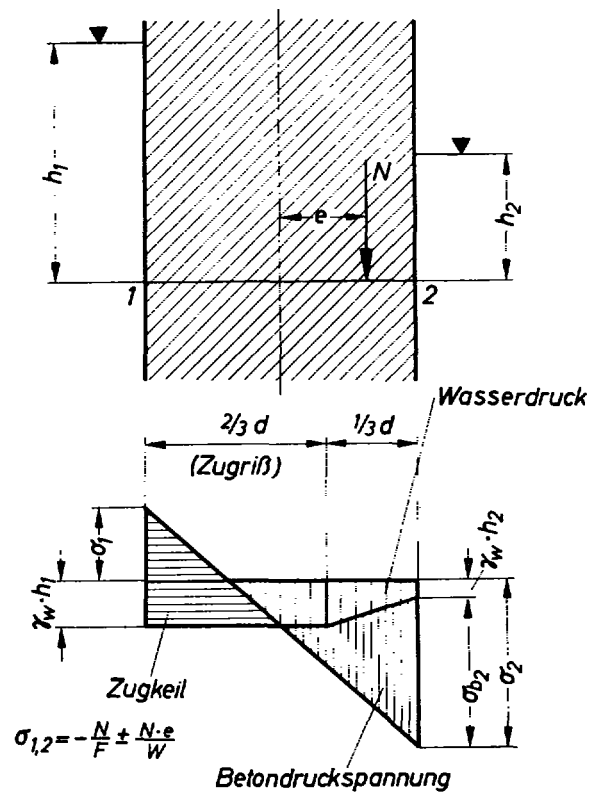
Annahme der Spannungsverteilung im Querschnitt eines bewehrten Betonbauteiles.
